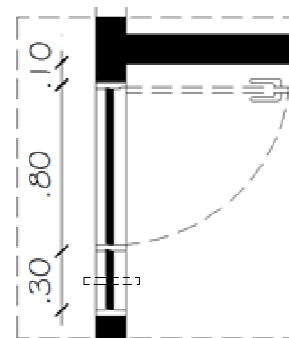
Detalhe ampliado da porta de entrada em planta baixa
